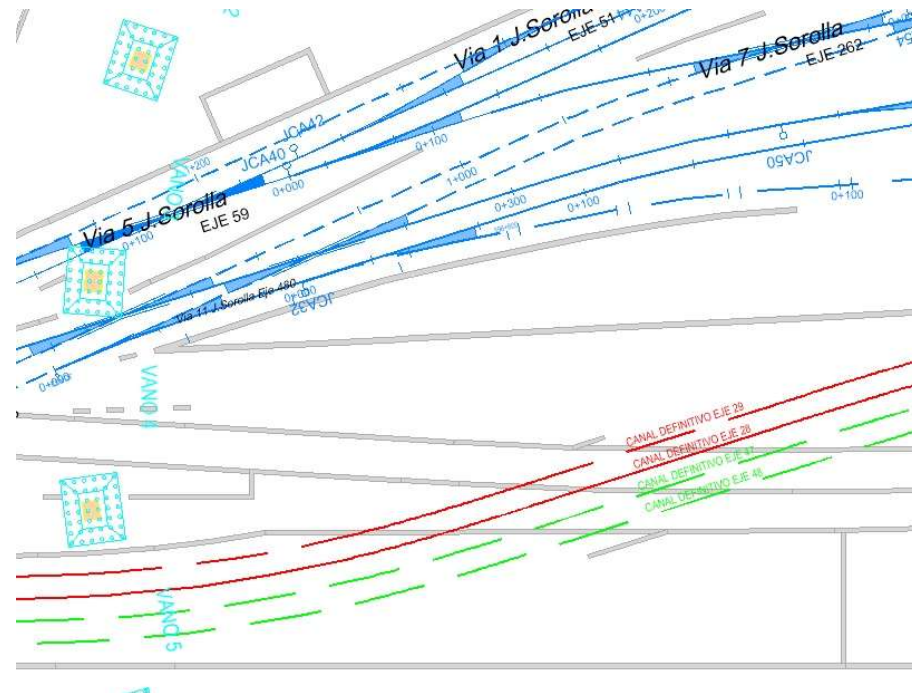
Planta de ejes y pantallas modificadas con pilas del puente Giorgeta. Fuente: planos de la oficina técnica
